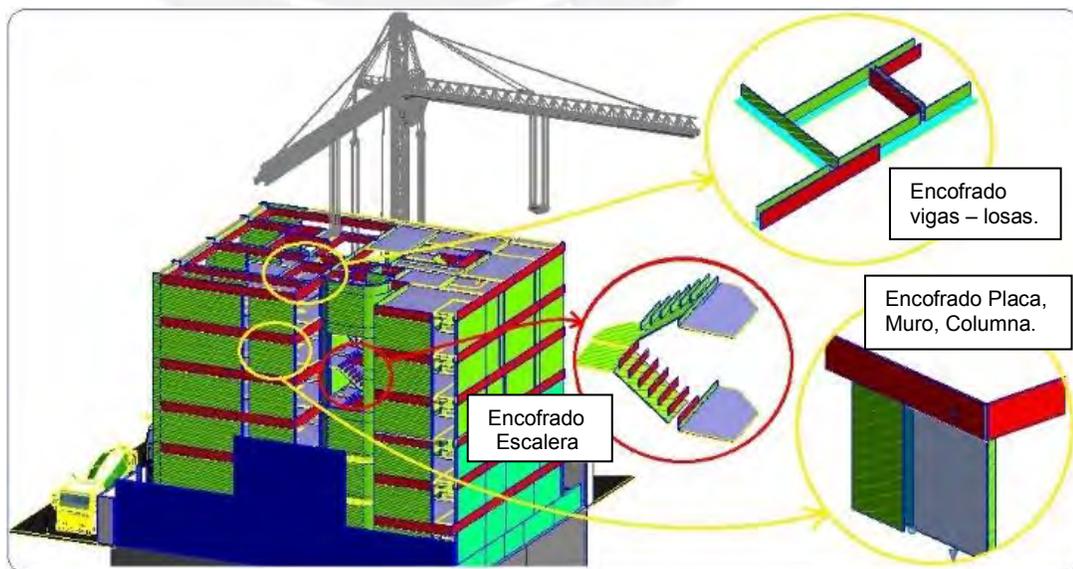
Modelo de paneles de encofrado.
